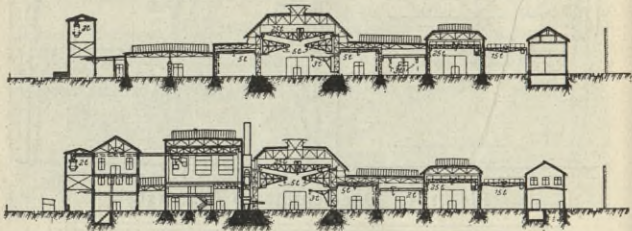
u. 124. Querschnitte zu Fig. 122.
